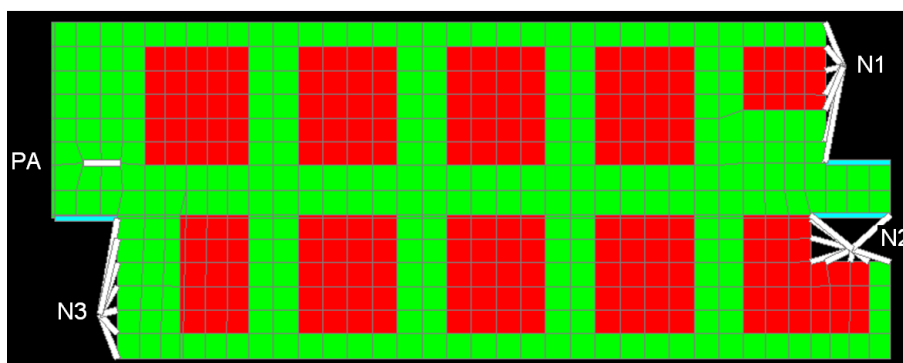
Vista em planta do piso tipo do modelo A (SAP2000)
